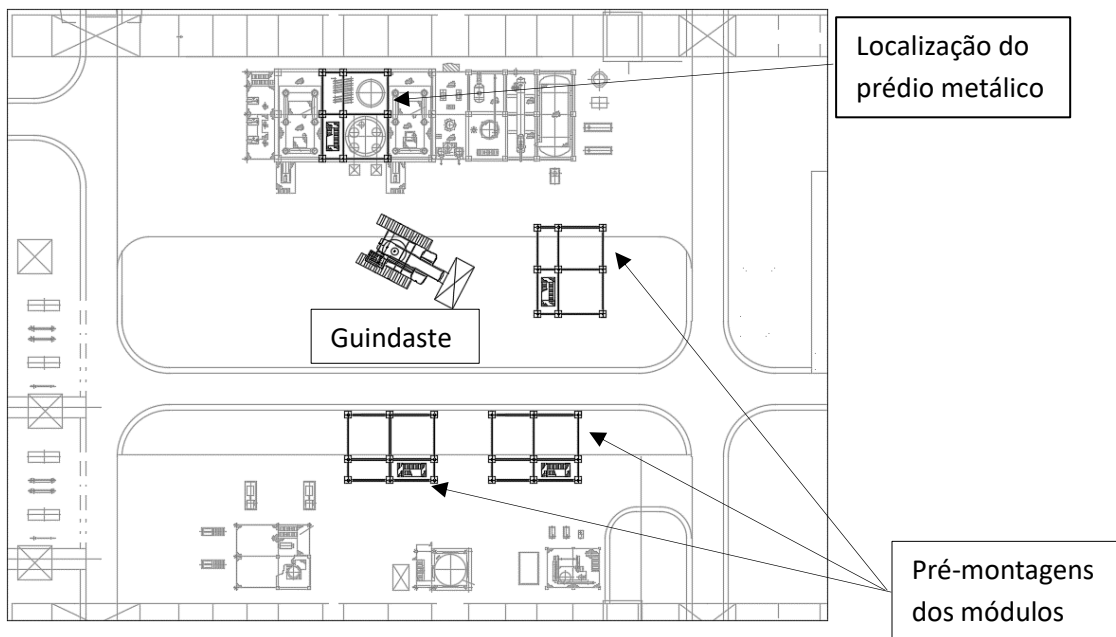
Layout da planta durante a montagem dos módulos. Fonte: os autores.
